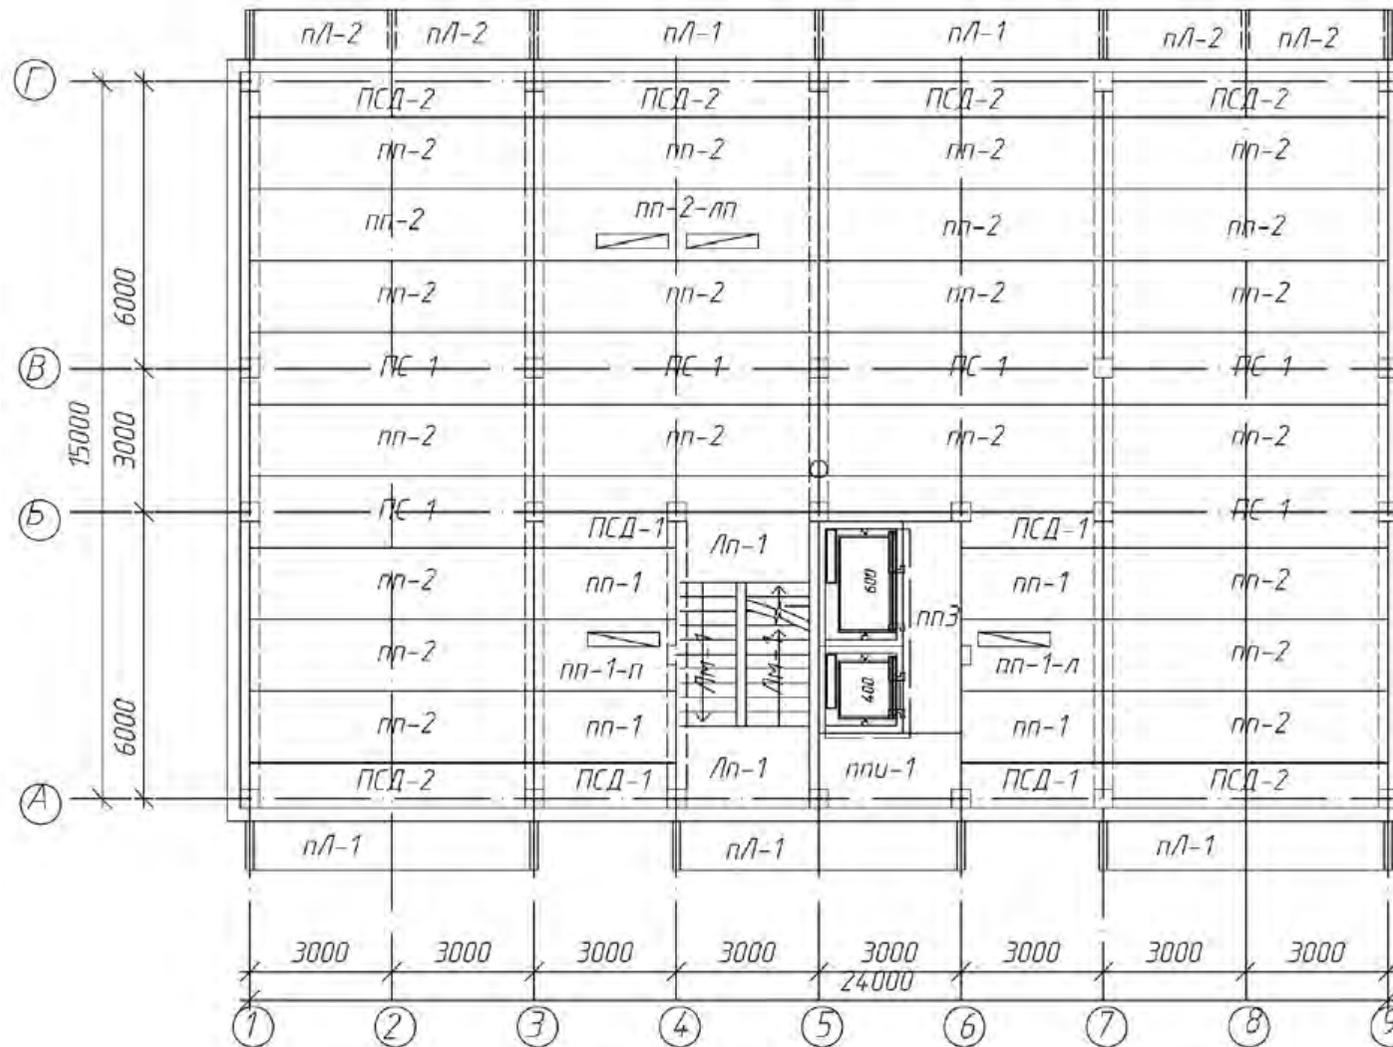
План перекрытия в здании с поперечным каркасом: ПС — плита связевая (плита-распорка); ПП — плита перекрытия сборная круглопустотная; ПСД — плита связевая доборная; ПЛ — плита лоджии
